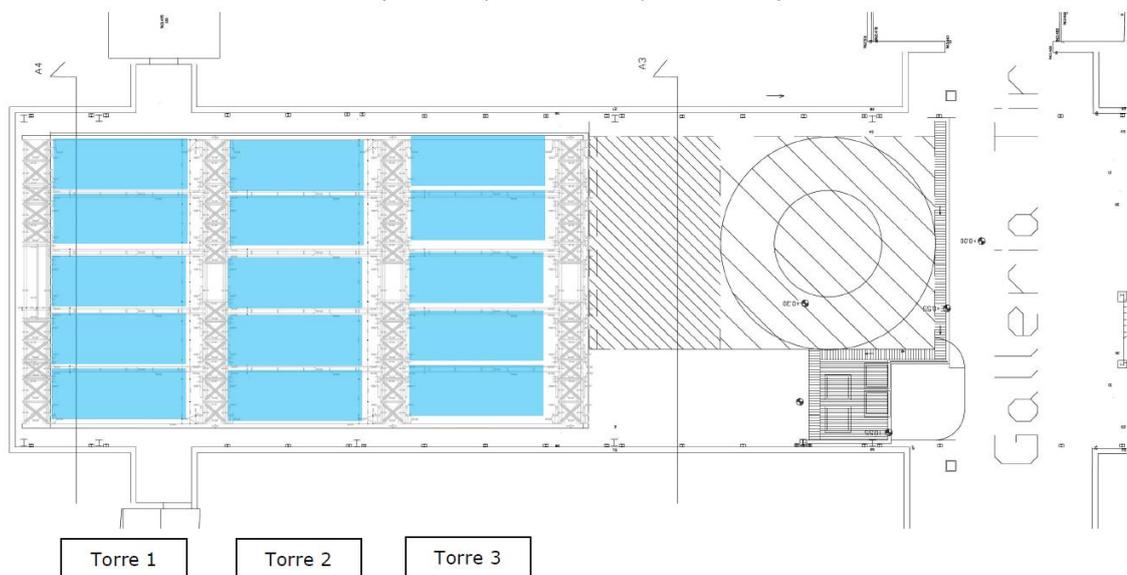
Planimetria di LVD con indicazione delle 3 torri
